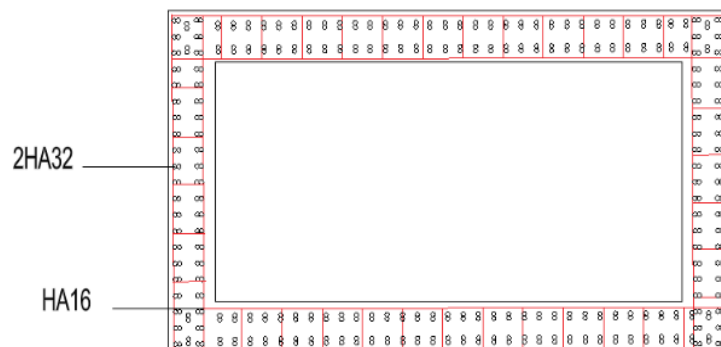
Schéma illustratif du ferrailage de la pile (coupe transversale vue en plan).
